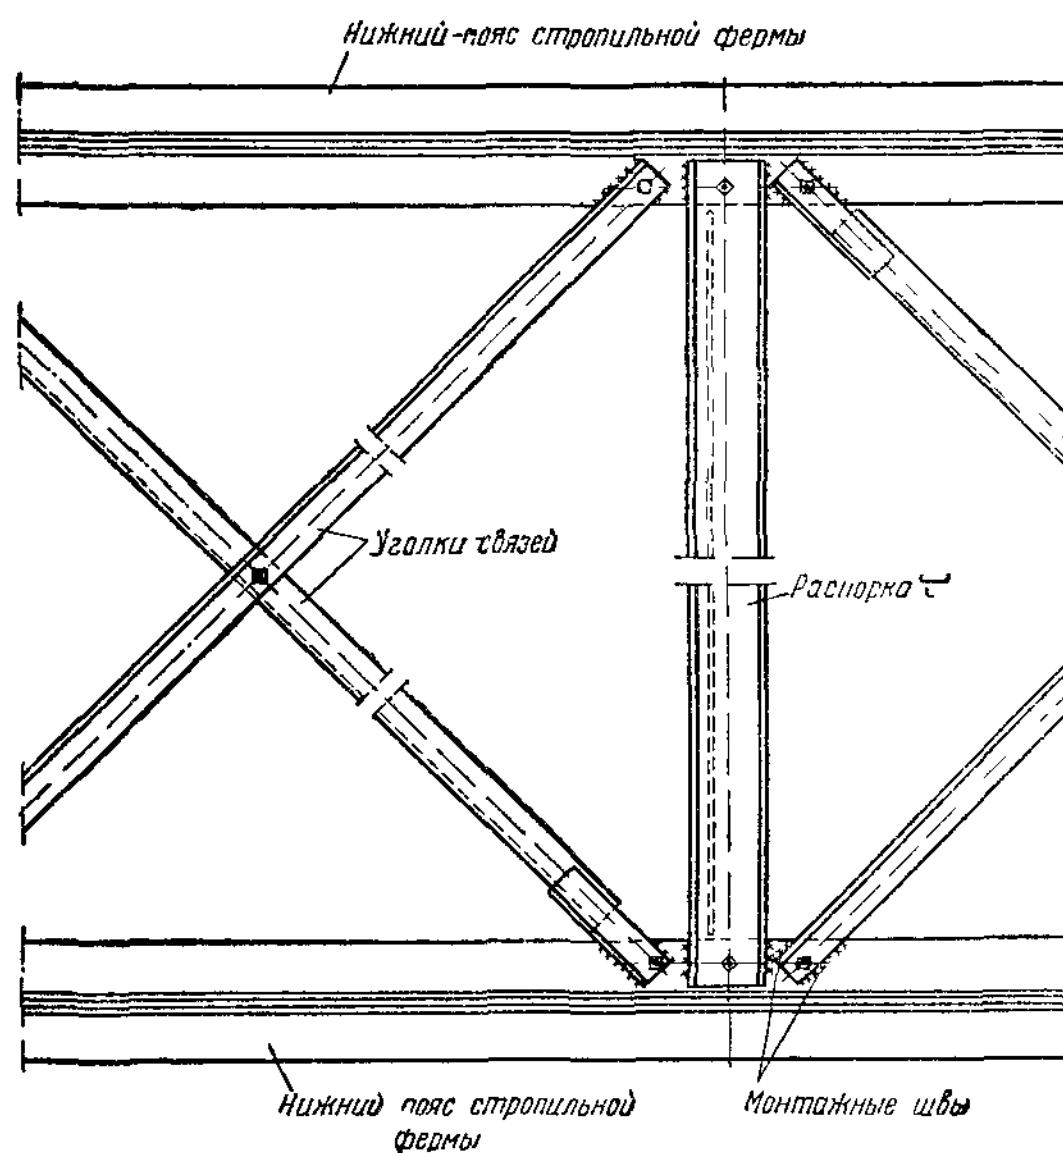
Прикрепление связей к нижним поясам ферм на сварке
